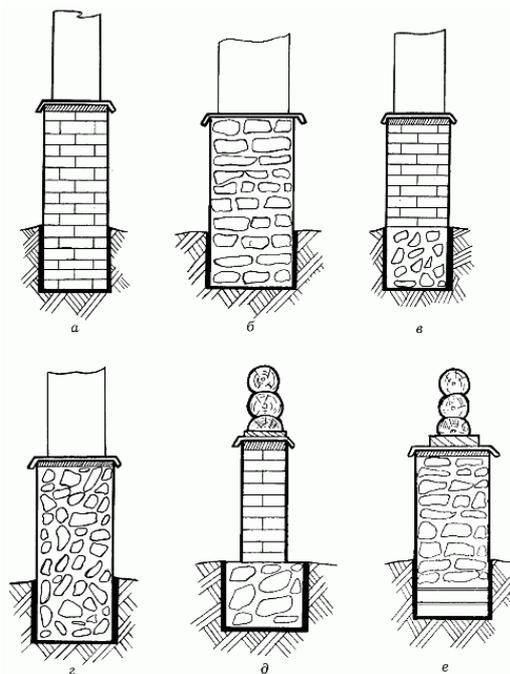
Фундаменты, сделанные из различных материалов: а – кирпичный; б – бутовый; в – кирпичный с бутобетоном; г – бутобетонный; д – кирпичный с бутом; е – бутовый на песчаной подушке
